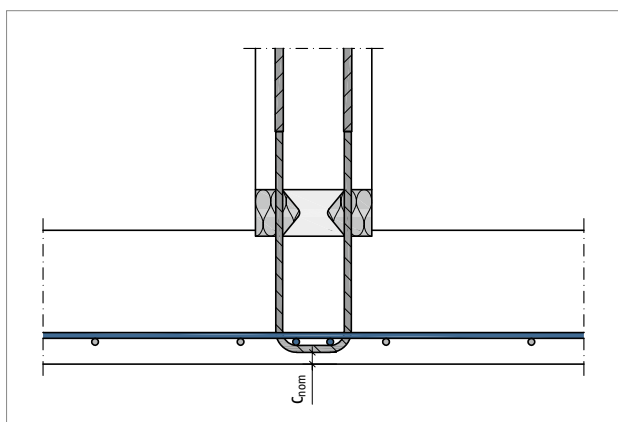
Schöck Sconnex® Typ W-N1T1-BW: Die erste Deckenlage ist in den Schöck Sconnex® Bügel eingefädelt
